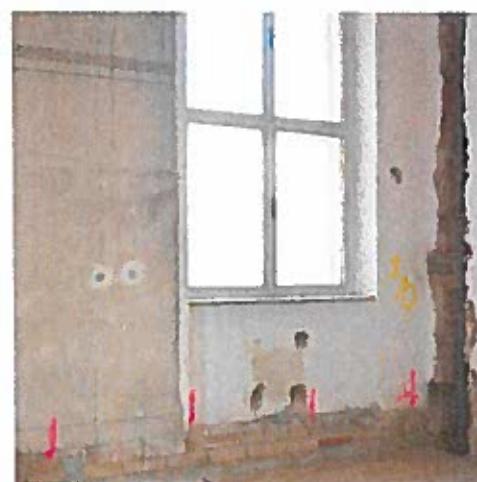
Zkušební místo B4, terče připravené k provedení zkoušky, detail
